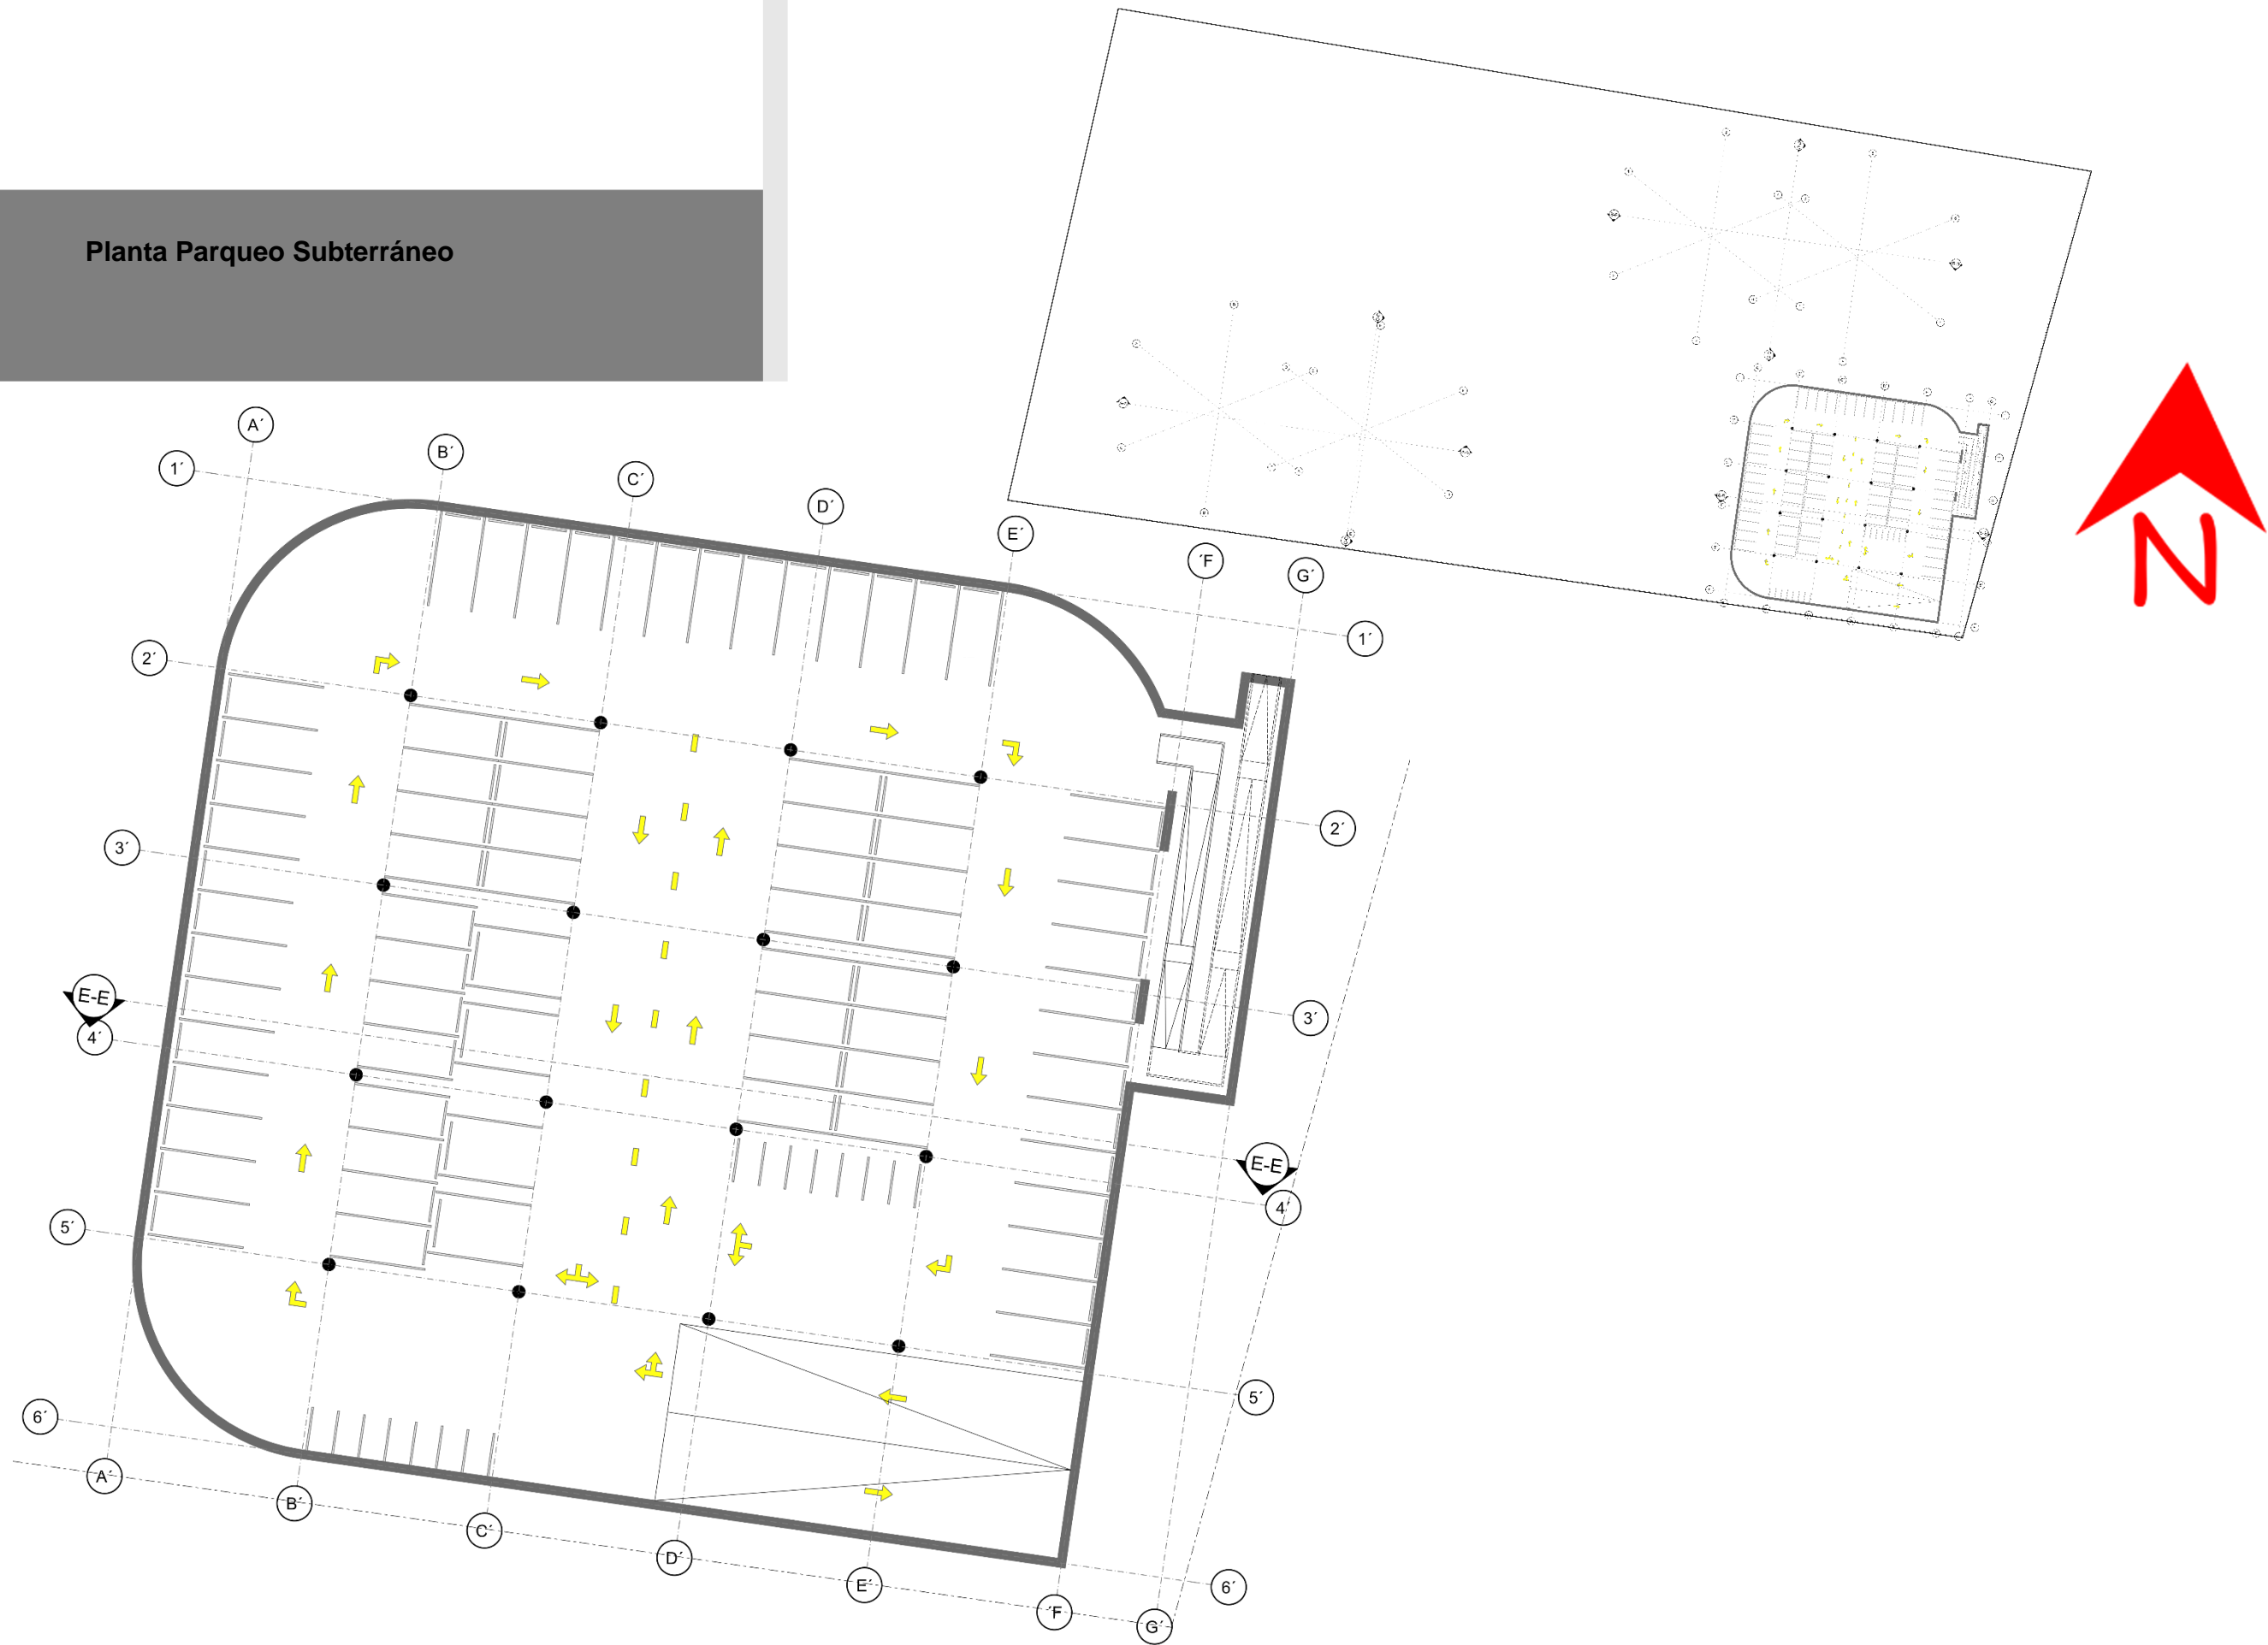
, Planta Arquitectónica Parqueo Subterráneo y su ubicación en el lote, Propiedad Personal, Tomada 2023
